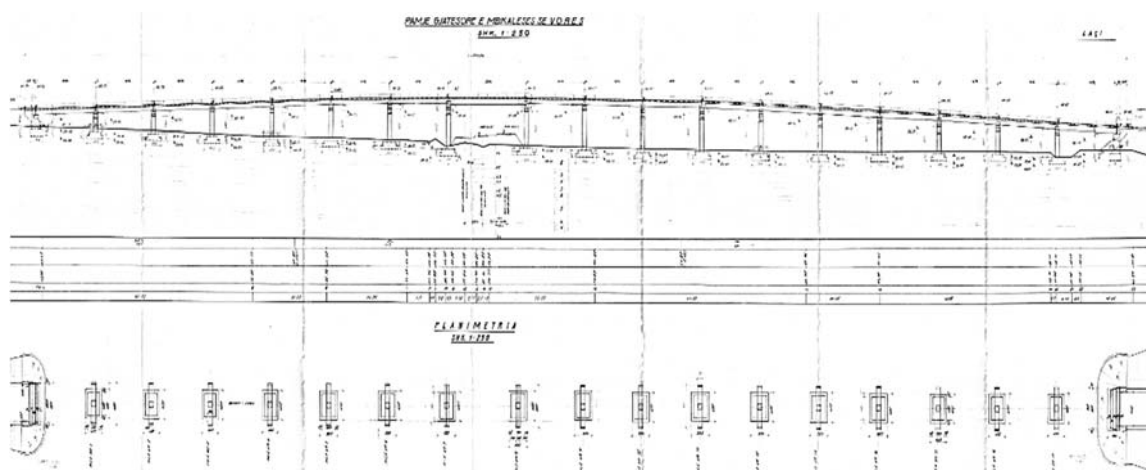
Pamje gjatësore dhe planimetria e mbikalesës së Vorës ([6])²
